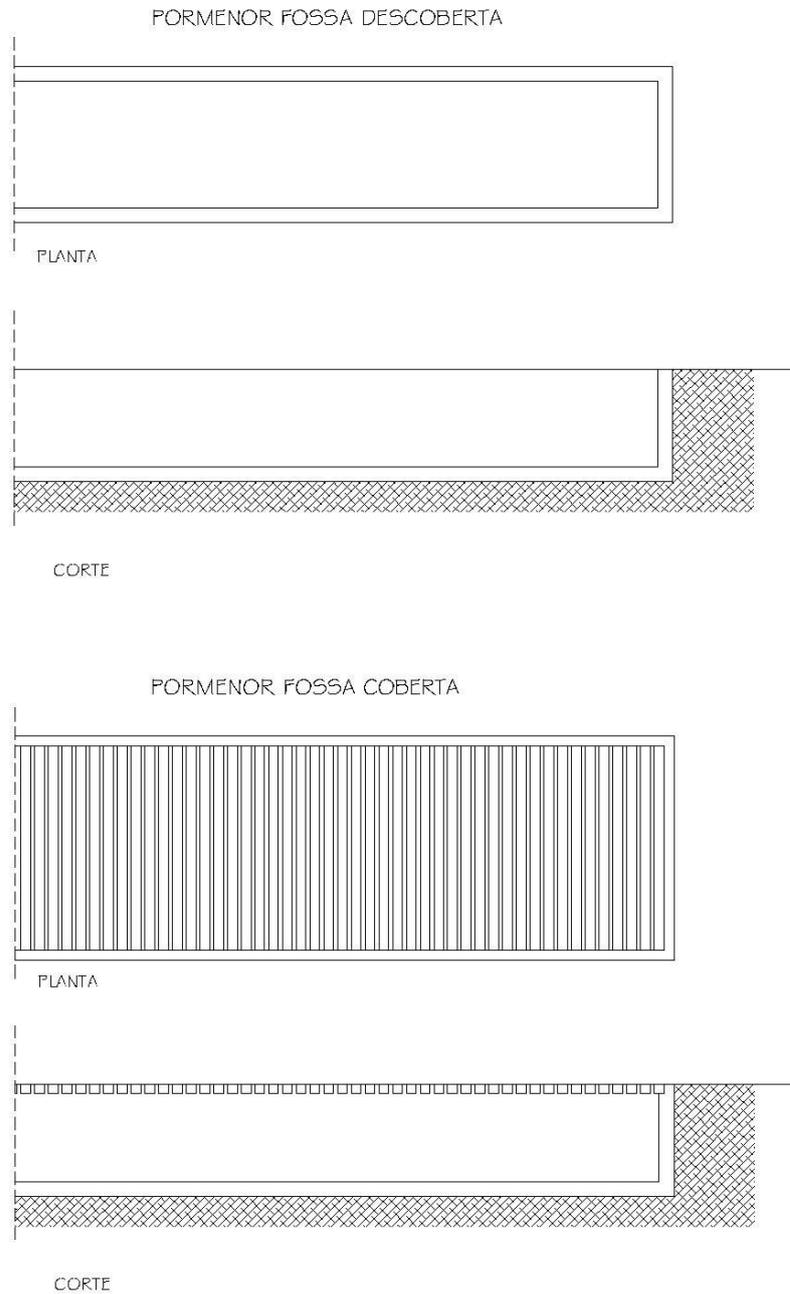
Fossas cobertas dos pavilhões (em corte). (Desenho 8).
